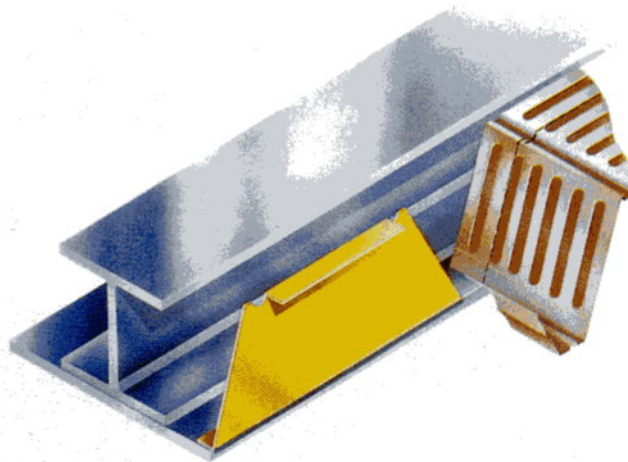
Systemdarstellung: SFB-Träger mit Profilsicken-Formteil und Trapezblech
